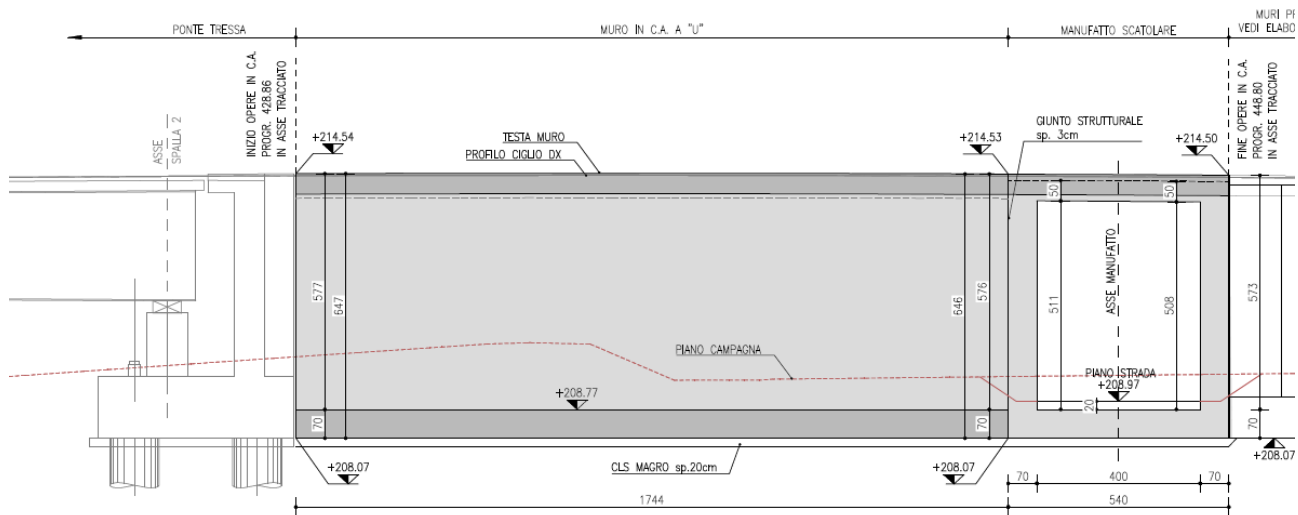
Scatolare e muro a U lato nord – carpenteria elevazioni
